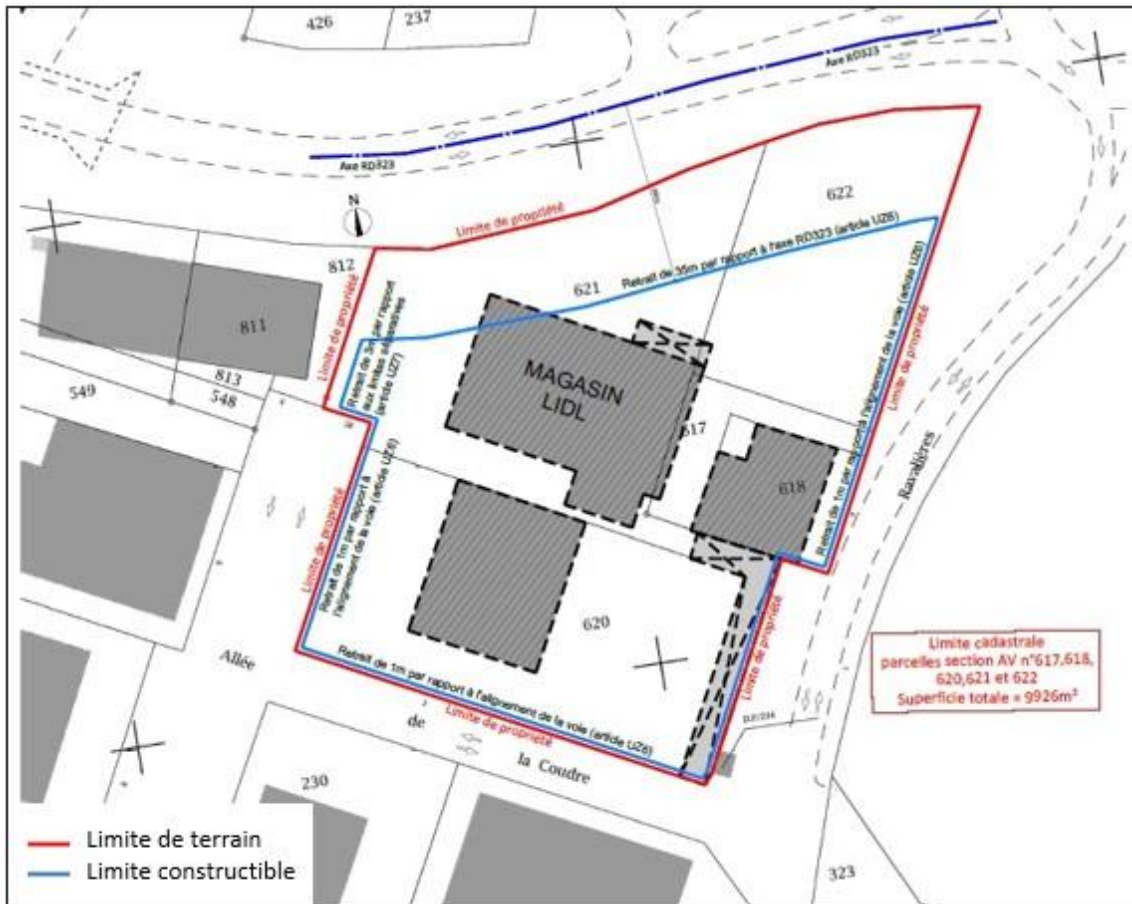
Extrait du plan cadastral de la commune de Changé – Situation actuelle du site
